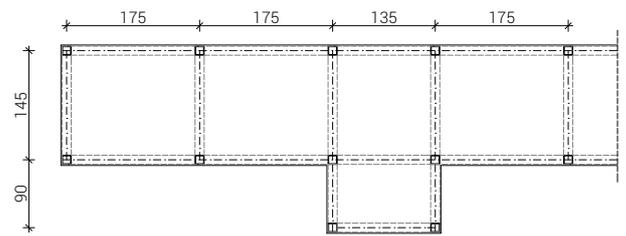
Ausschnitt Grundriss Laubengang
